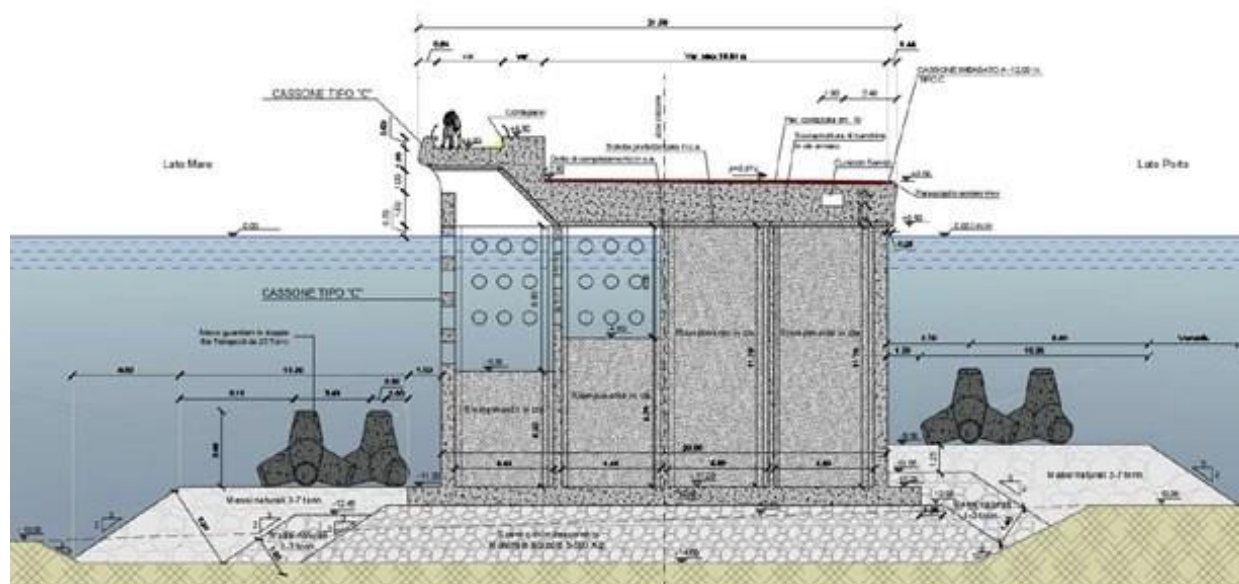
Sezione tipo A'-A' (Cassone tipo C)
